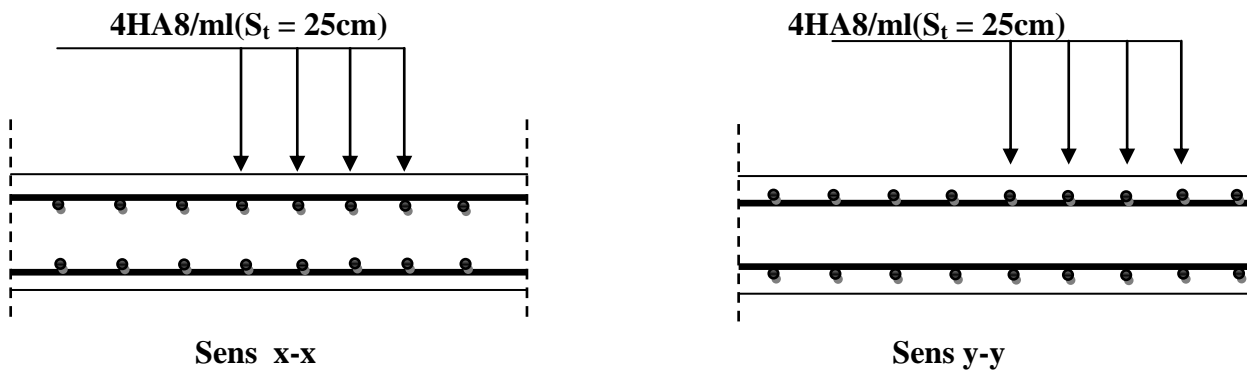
Ferrailage de la dalle pleine de la salle machine.
